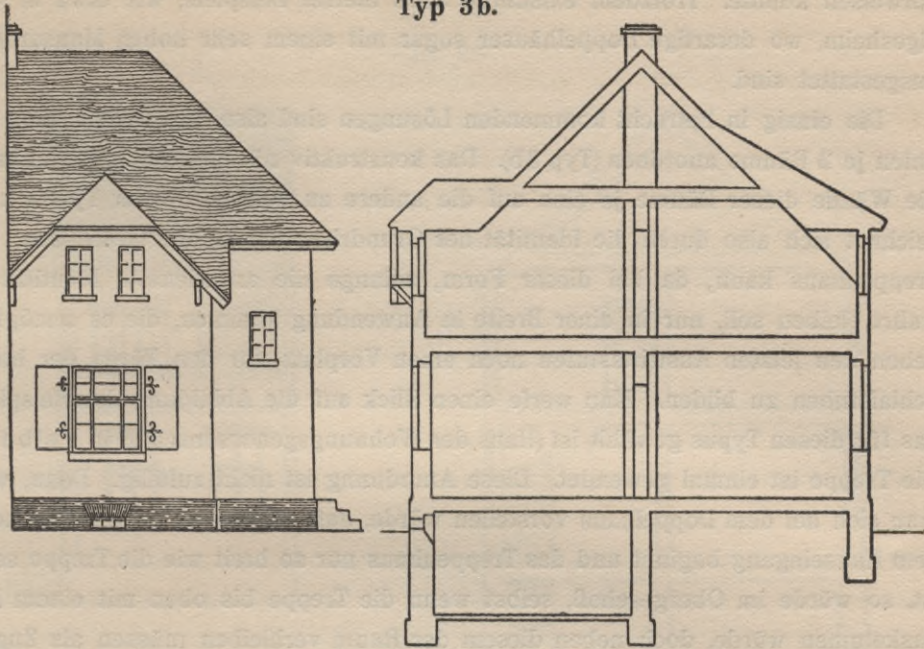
Typ 3b: Vier Wohnräume, so angeordnet, daß Erd- und Obergeschoß gleichartig geteilte Grundrisse haben (Doppelhaus). Beispiel nach einem Hause der Wohnungsgenossenschaft in Velbert. (Vgl. Festschrift a. a. O.)
